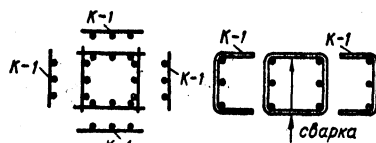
Поперечные сечения стоек, армированных одним типом сварных каркасов.
